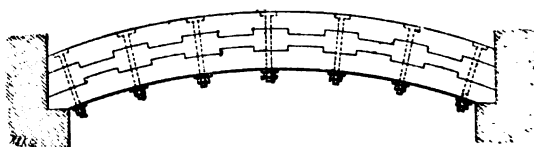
Assemblage par crénelures pour pièces jumelées.
